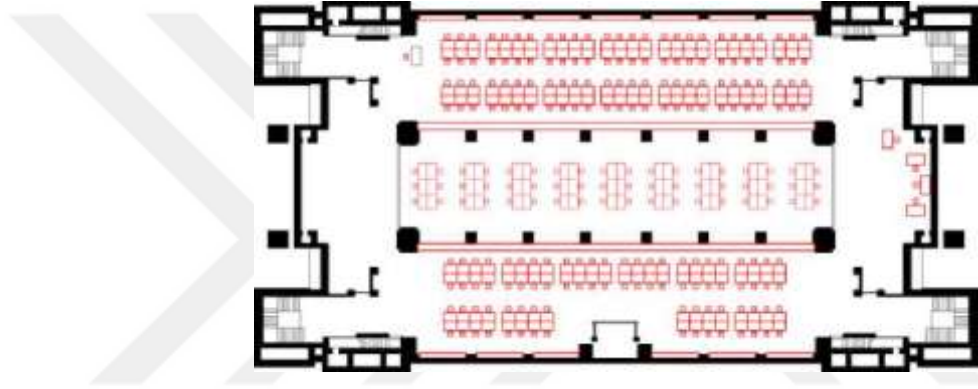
Wainwright Binası Planı (St. Louis, 1890) (Url-10).
